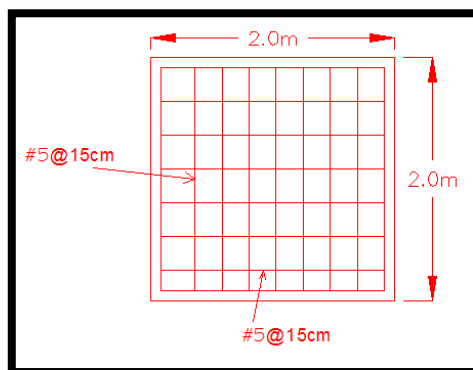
Sección transversal de la zapata con medidas y distribución de acero
